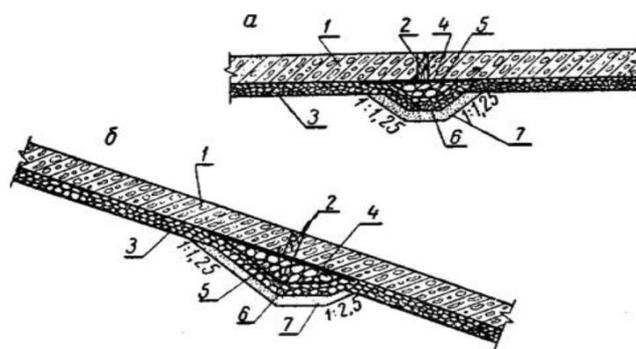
Ленточный фильтр под железобетонными плитами: а - продольный разрез; б - поперечный; 1 - железобетонная плита; 2 - доски толщиной 2 см, пропитанные креозотом; 3 - утрамбованный гравий или щебень толщиной слоя 10 см; 4 - бумажная прокладка (смоченные бумажные мешки из-под цемента); 5 - гравий или щебень крупный; б - то же, мелкий толщиной слоя 15 см; 7 - крупнозернистый песок толщиной слоя 10 см
